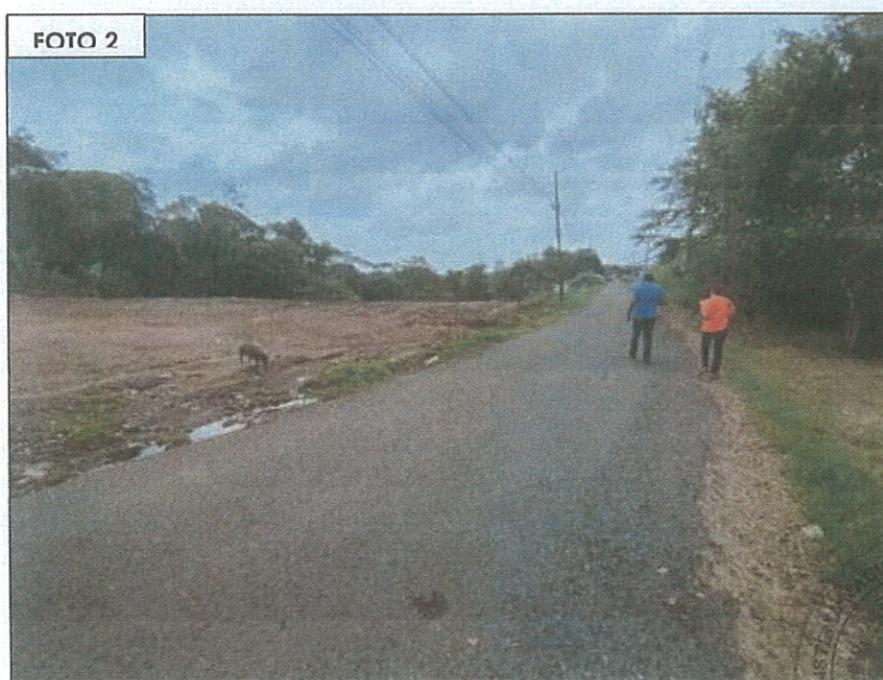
VISTA GENERAL DEL ÁREA DEL TERRENO Y LA CALLE PRINCIPAL
